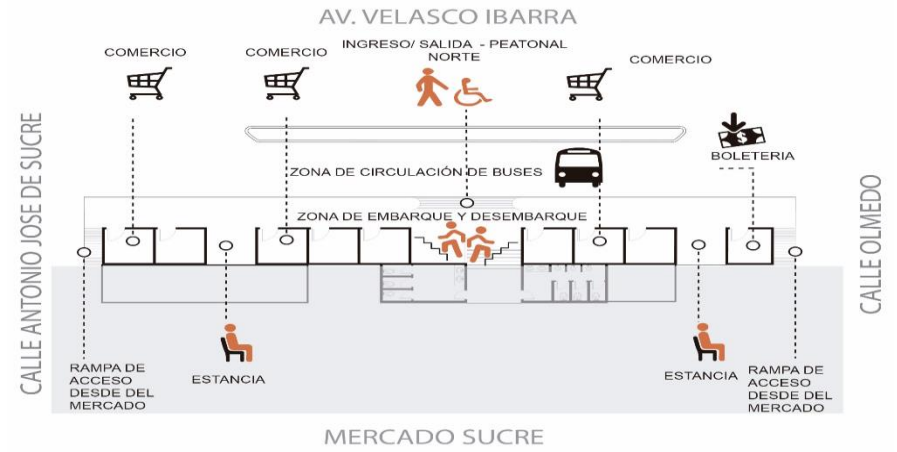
Vista lado sur Terminal Terrestre - Subsuelo
